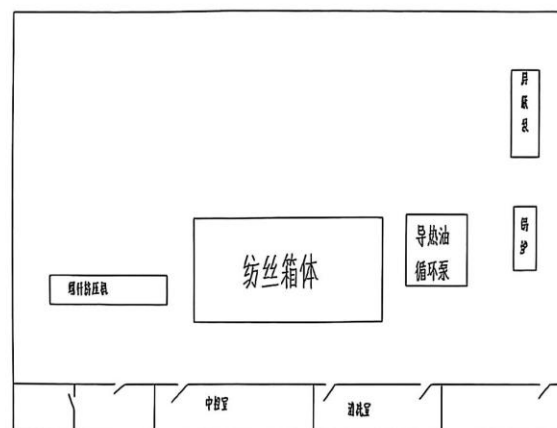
翔鹭涤纶纺纤（厦门）有限公司总平面布置图
